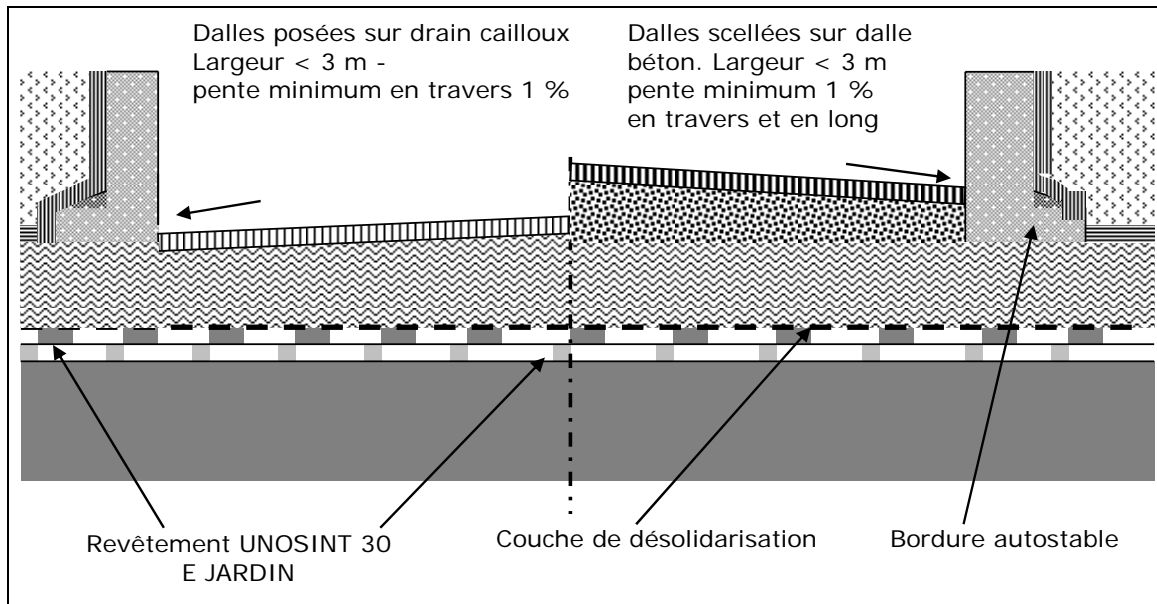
Chemin de circulation sur couche drainante ou dalle béton
